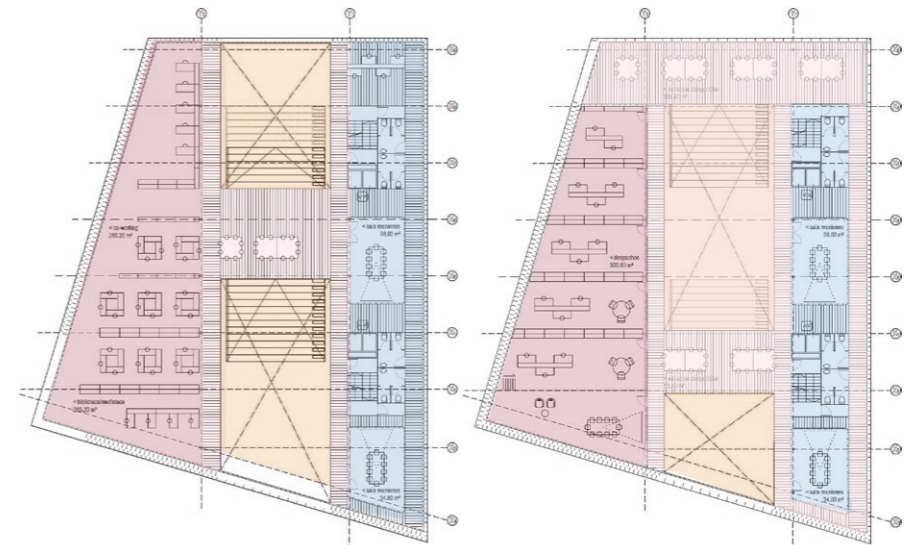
Planta segundo piso. Adaptado de Plataforma de Arquitectura, 2016
